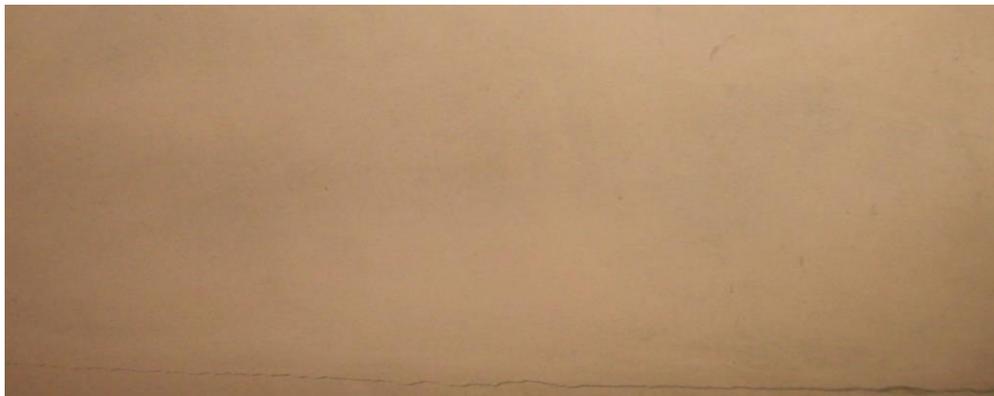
Exemplo de fissura horizontal na base da parede.
